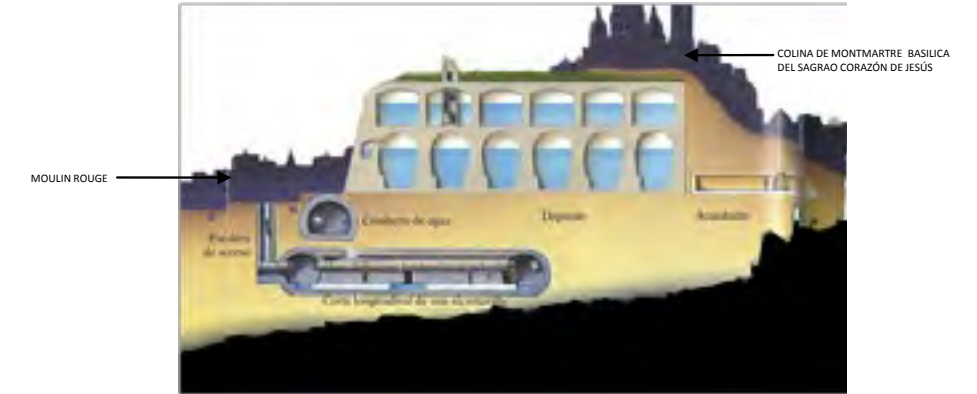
Corte esquemático barrio de Montmartre, París. ¹⁶
